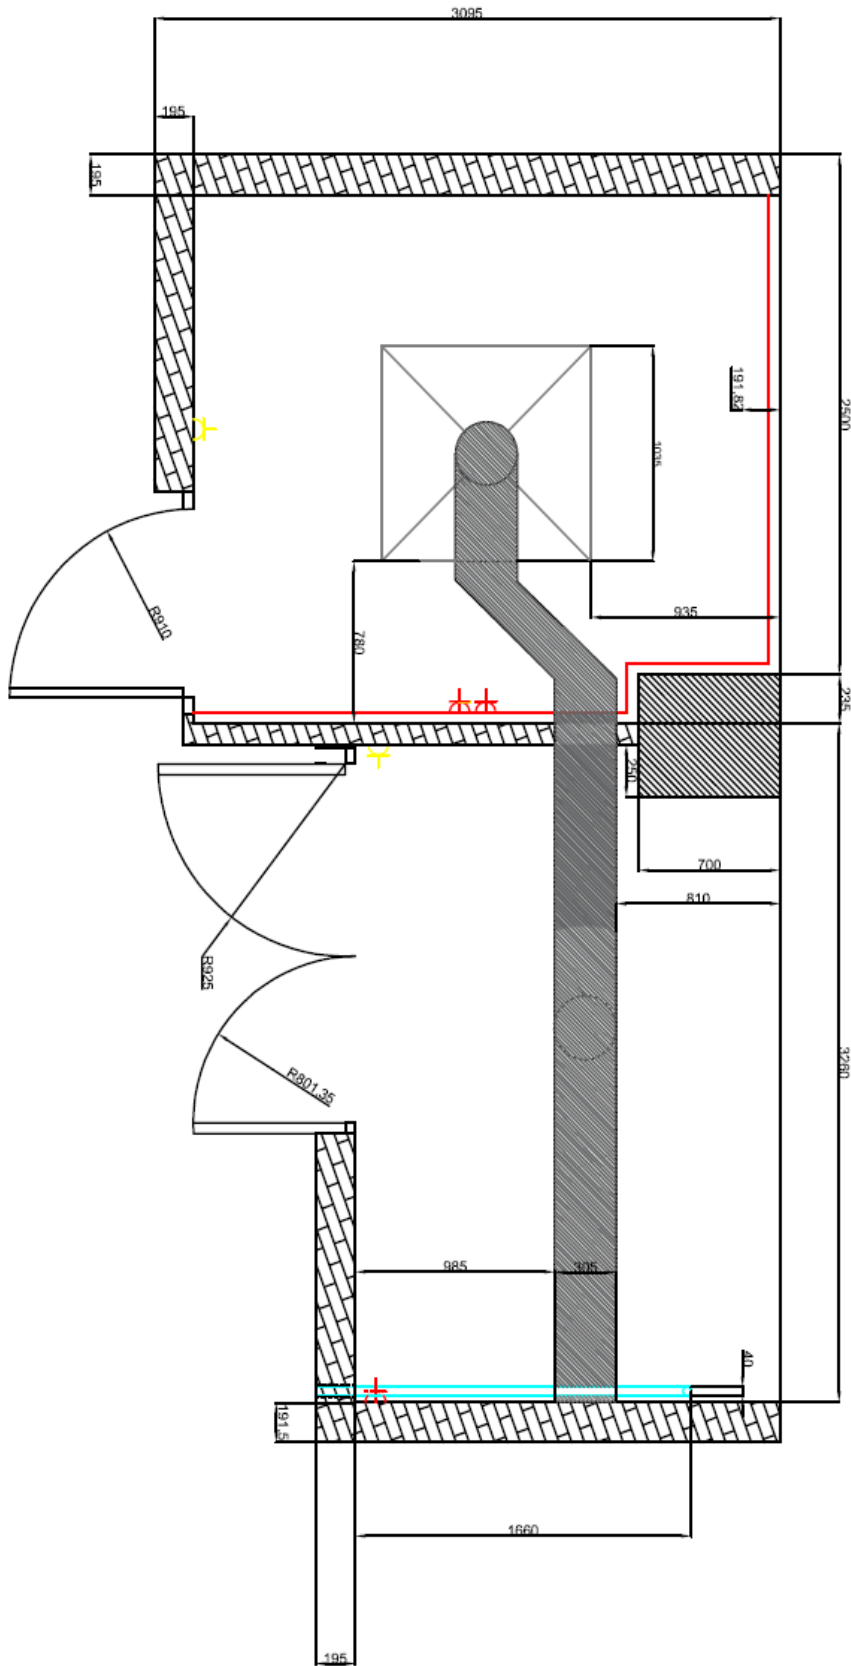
Vista en planta conjunta de las salas 1 y 2. Fuente: propia. Realizado en AutoCAD.
